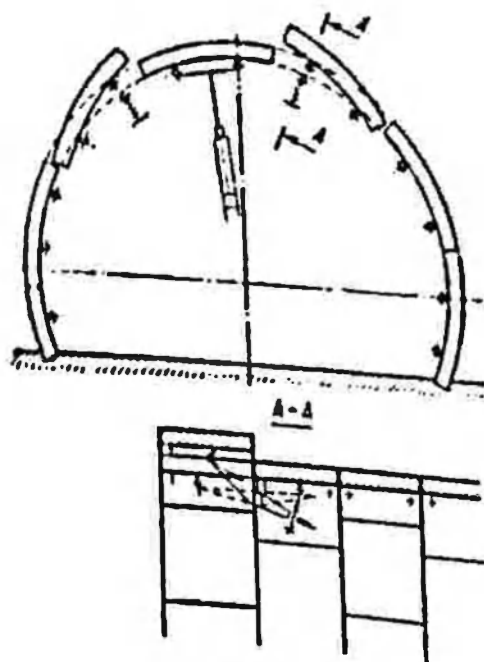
Схема установки верхних тюбингов с помощью монтажного приспособления
